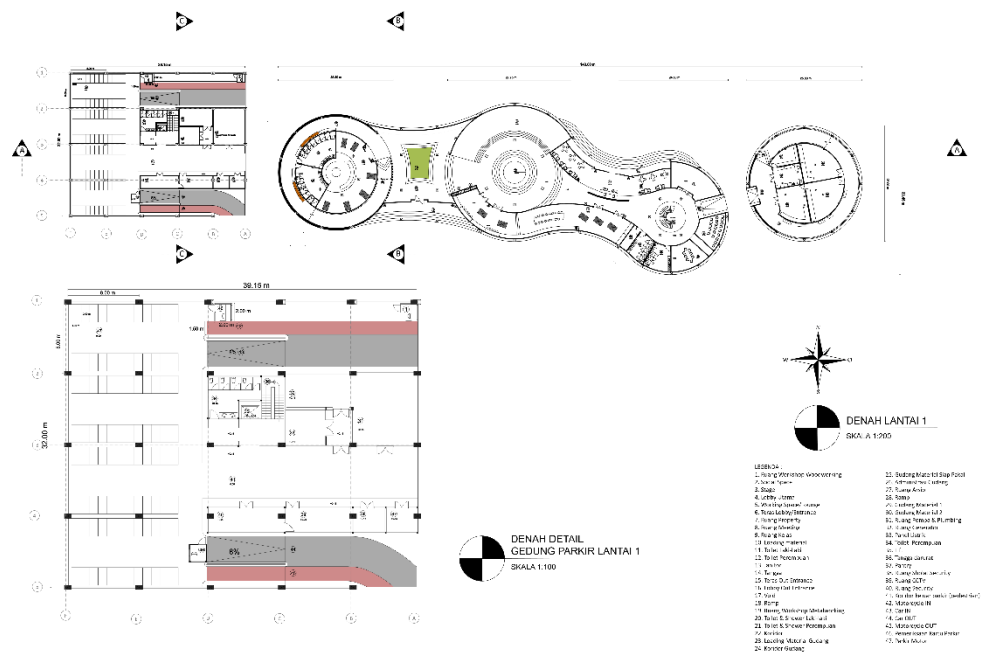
2 Layout Bangunan (Ilustrasi Penulis)
